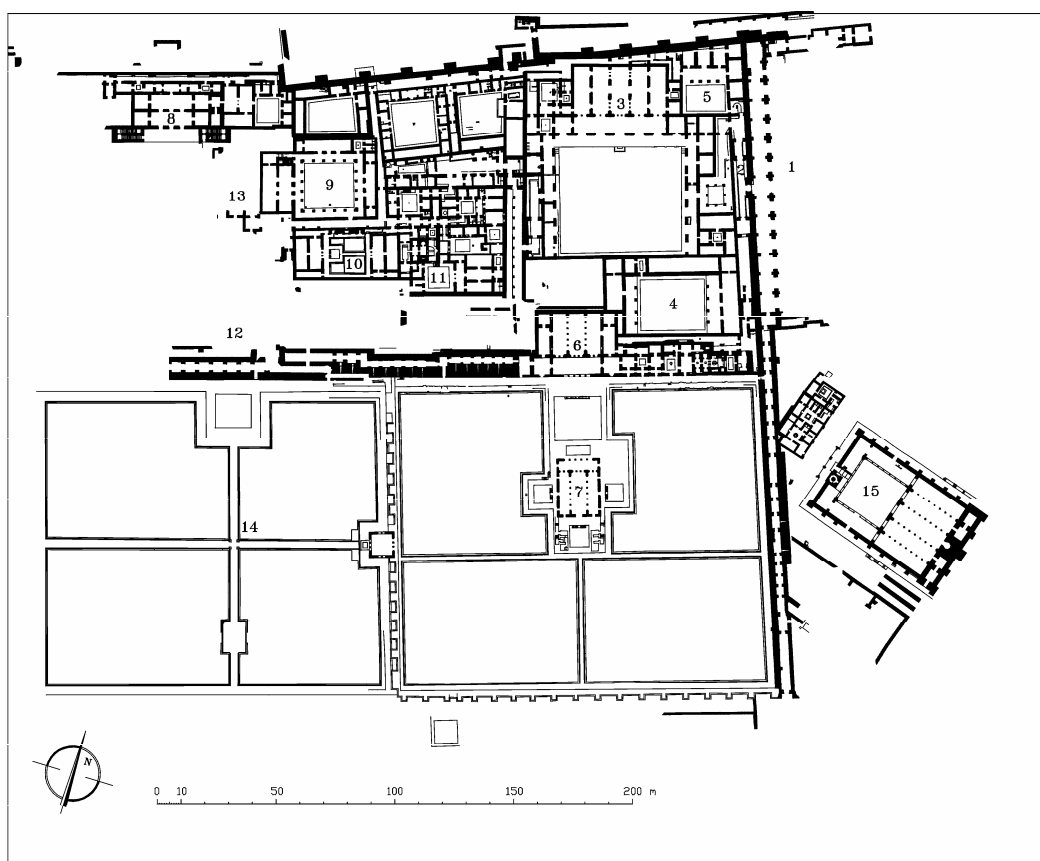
Planta del área excavada del Alcázar de Madīnat al-Zahrā': 1.- Explanada y pórtico de acceso. 2.- Corredores de acceso a la Dār al-Āund. 3.- Dār al-Āund. 4.- Dār al-Wuzarā'. 5.- Casa junto a la Dār al-Āund. 6.- Salón Oriental (Salón Rico). 7.- Pabellón Central de la terraza alta. 8.- Dār al-Mulk. 9.- Patio de los Pilares. 10.- Casa de la Albuquerra. 11.- Casa de Yafar. 12.- Salón Occidental? 13.- Salón de las dobles columnas. 14.- Jardín bajo de cruce. 15.- Mezquita.
